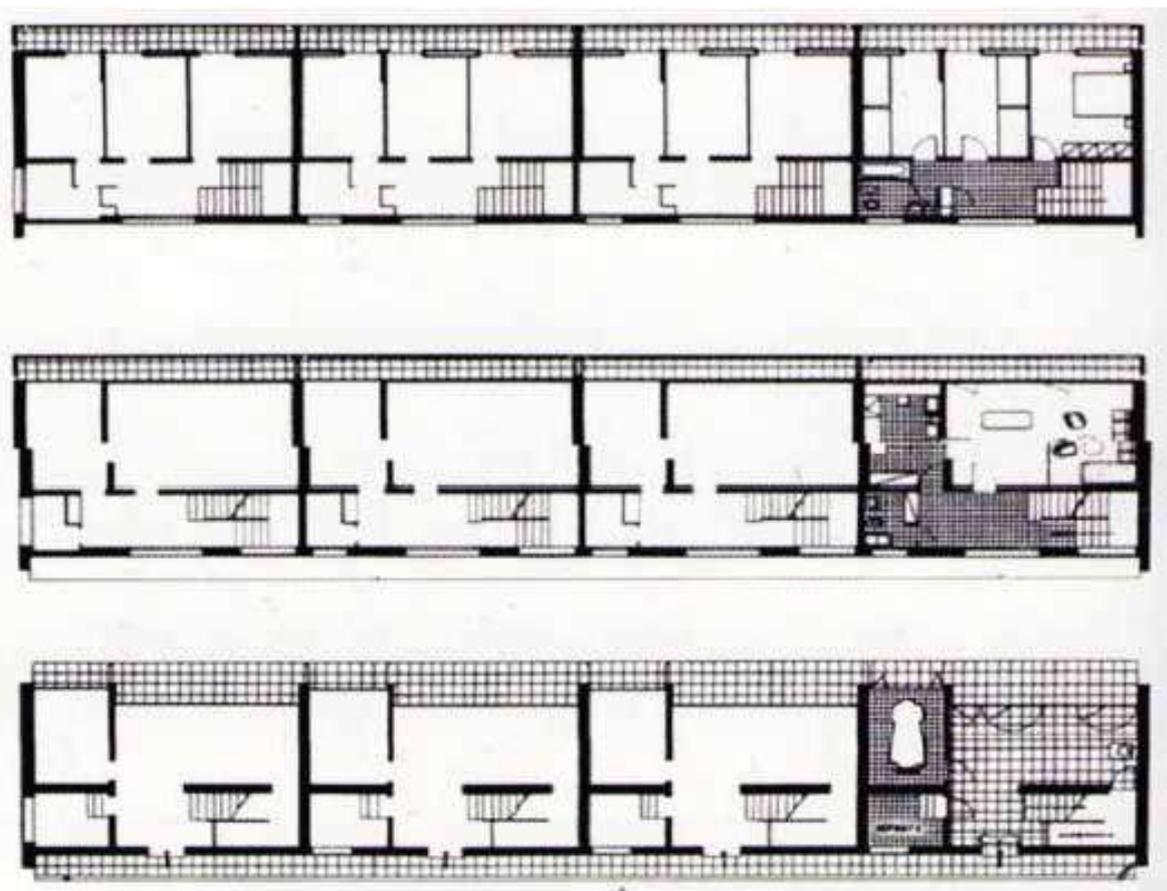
Grundrisse, Wohngebäude für Großfamilien, Figini und Pollini, 1941
